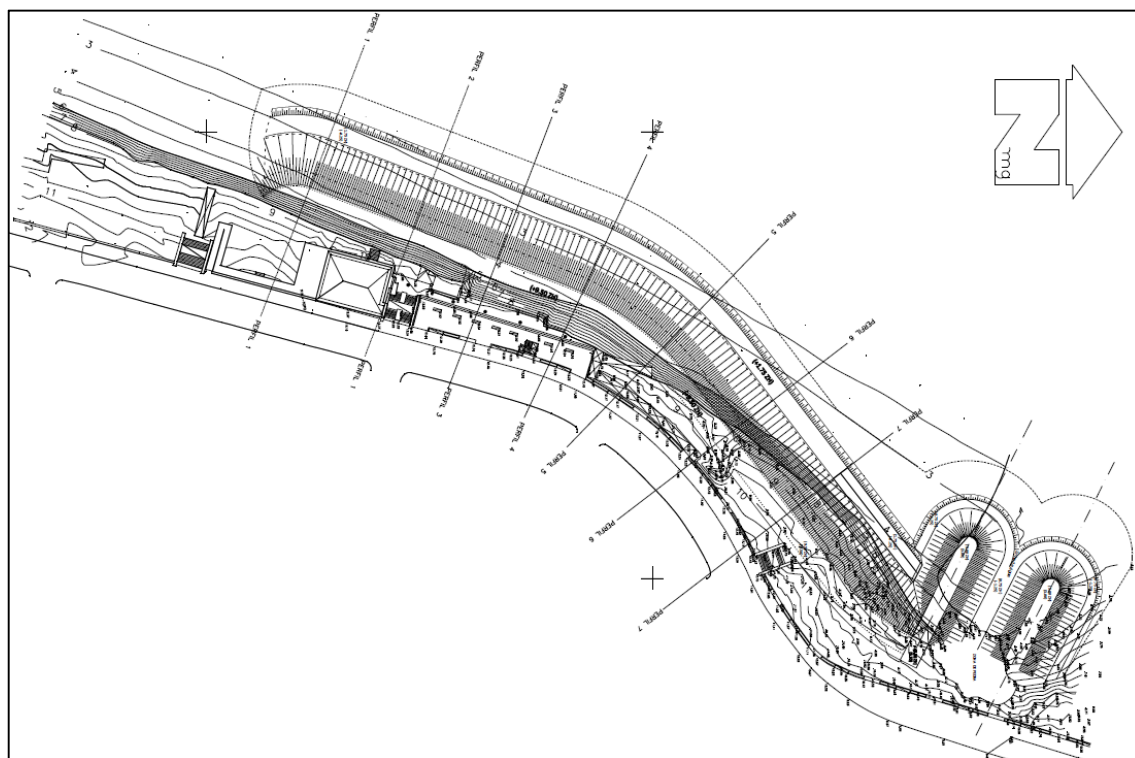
Troço do Centro Azul – Planta (fonte: APA, fevereiro de 2014)
